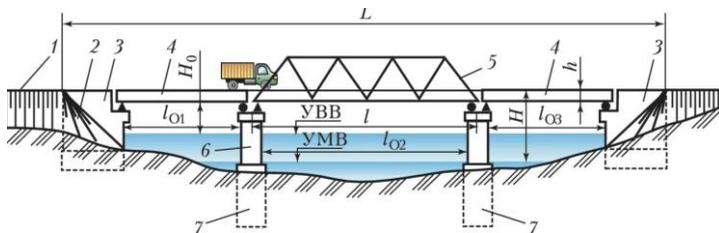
Балочный 3-пролетный мост и его элементы: 1 – насыпь подхода; 2 – конус насыпи; 3 – устой; 4 – пролетное строение с ездой поверху; 5 – пролетное строение с ездой понизу; 6 – промежуточная опора; 7 – фундамент опоры
